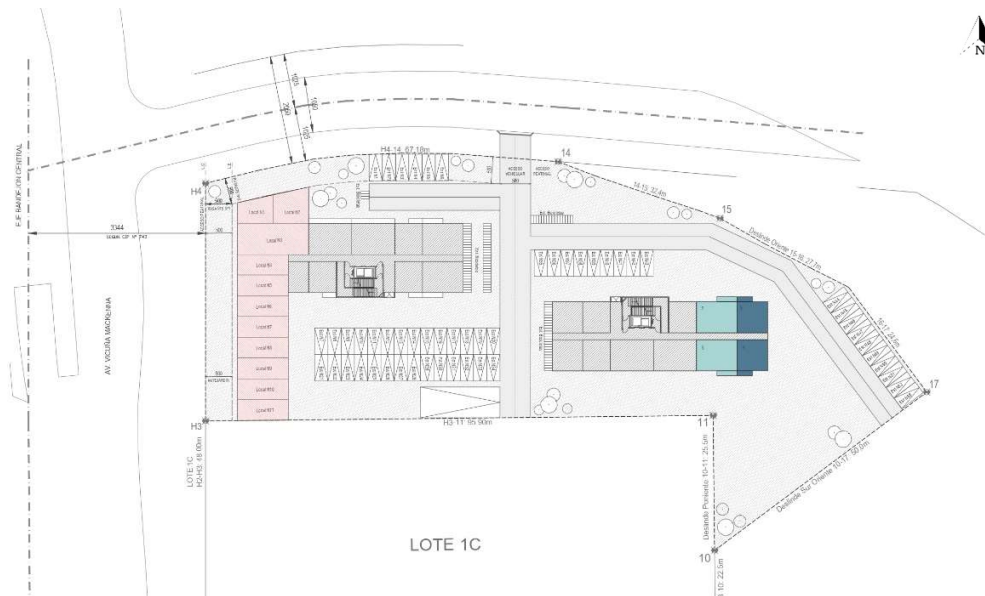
Planta 1° nivel (Sin escala). Fuente: Elaboración propia
